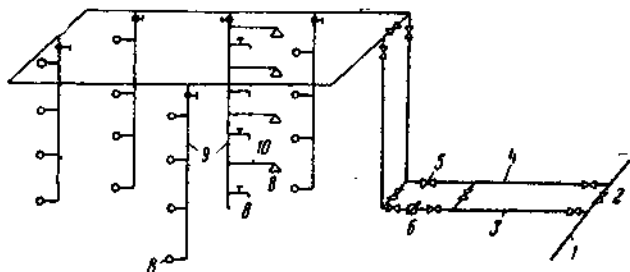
Схема внутренней водопроводной сети с верхней разводкой
